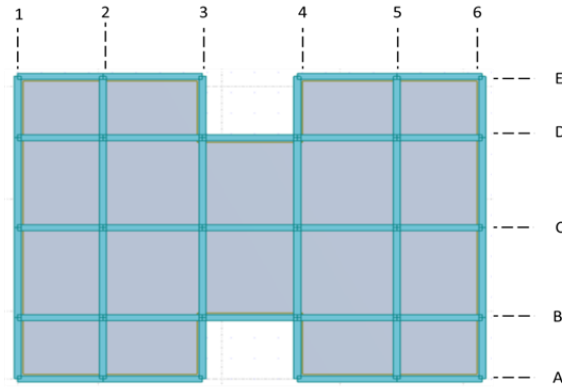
Vista en planta de los modelos M26RC, M27M y M28M
